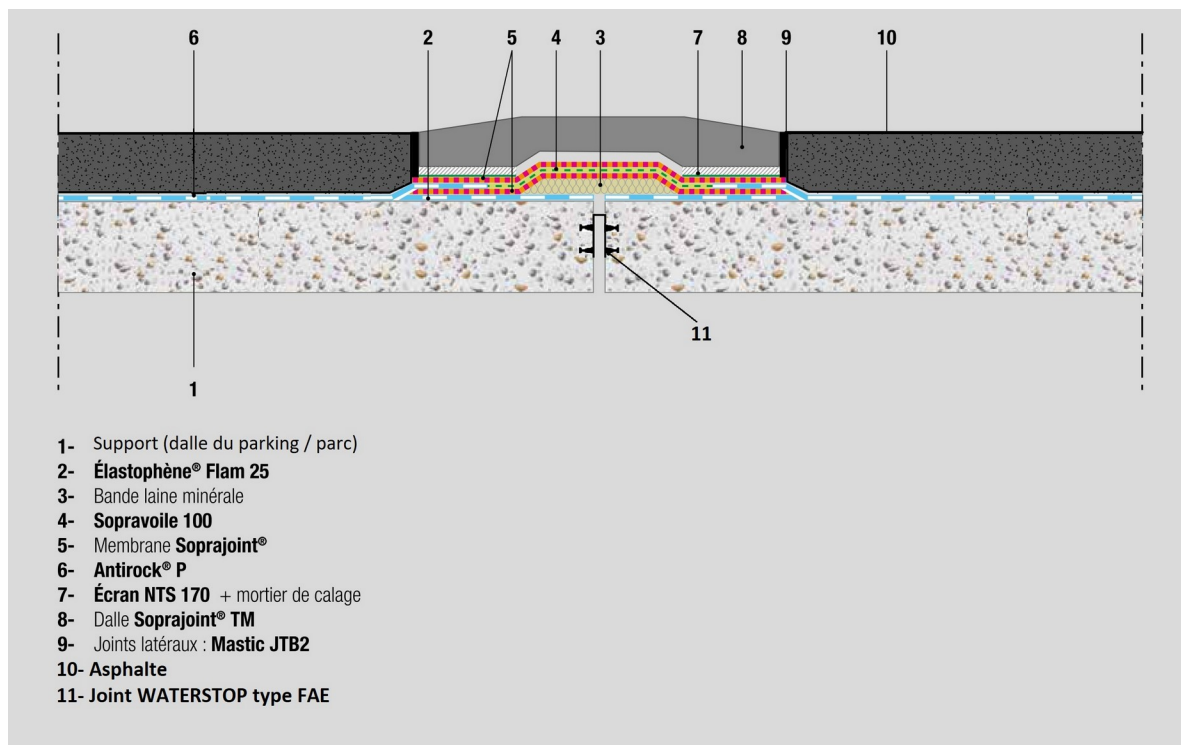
Coupe sur joint de dilatation du parc avec revêtement d'étanchéité (FPA)
